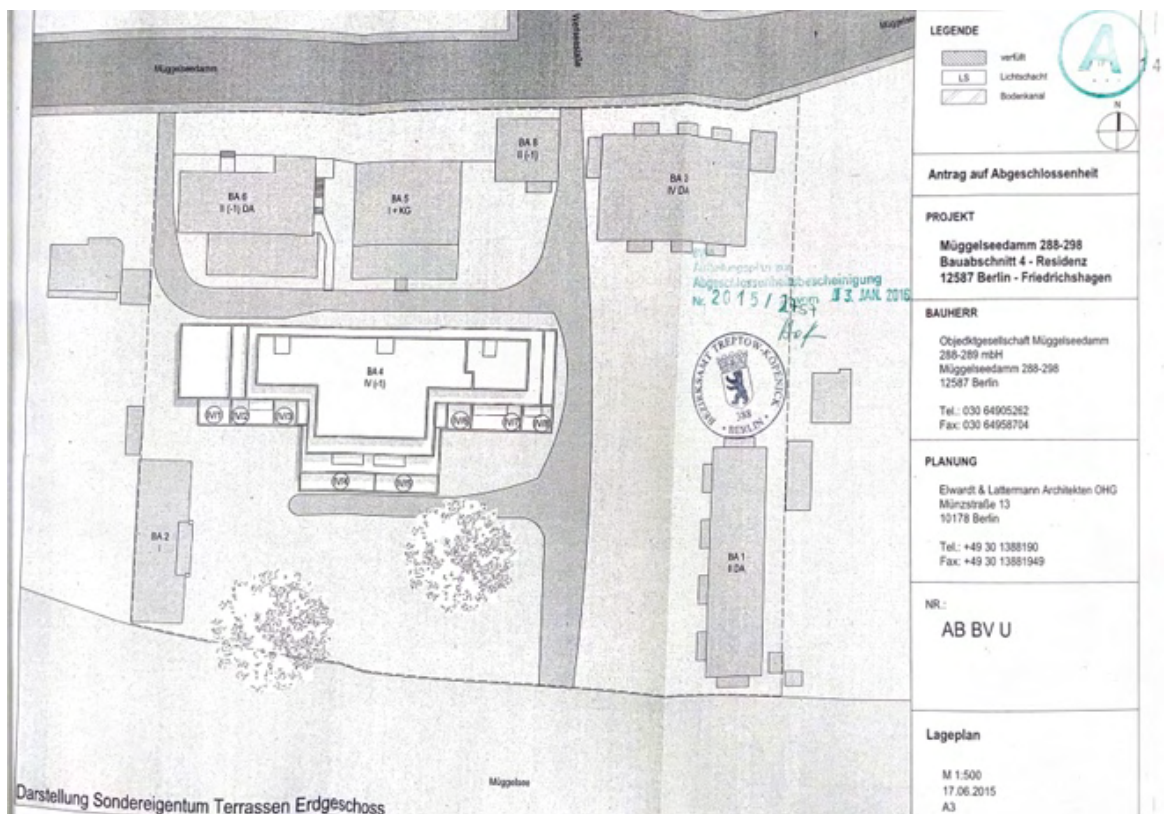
Lageplan der Gesamtanlage (Planstand 2015)
